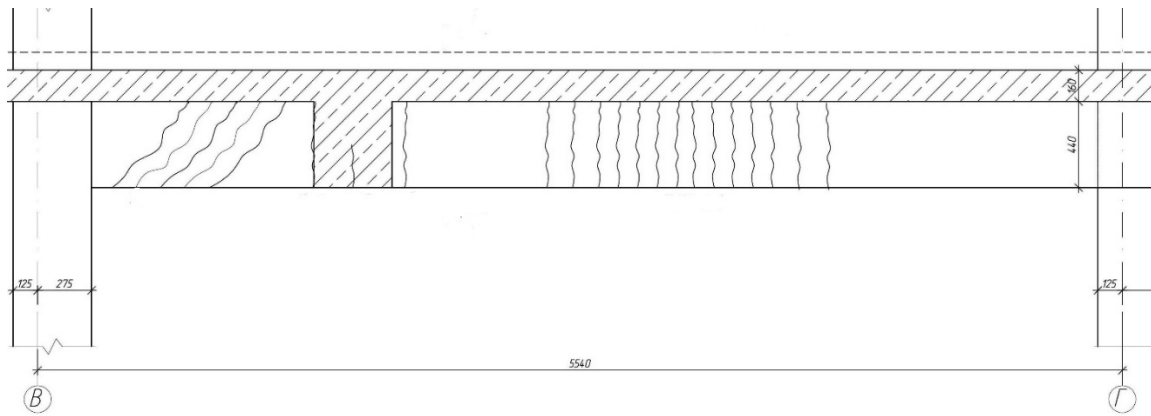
Схема розташування тріщин на поверхні поздовжньої балки перекриття над підвалом
